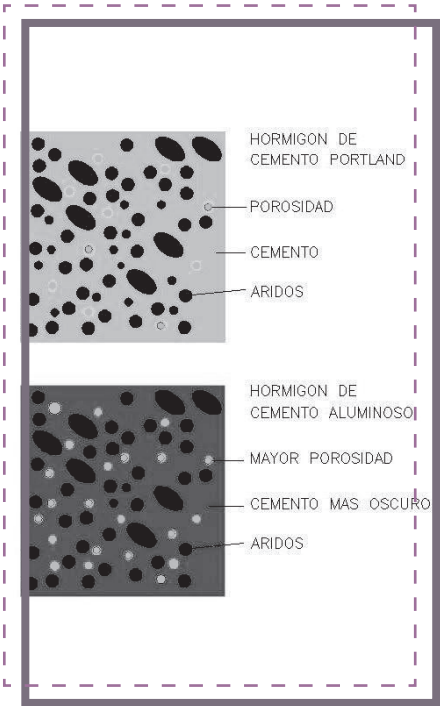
Esquema de proceso de aluminosis en hormigón armado.
